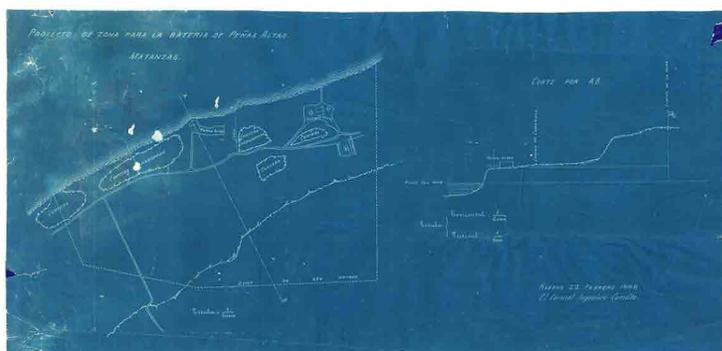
Plano y perfil del proyecto de zona para la batería de Peñas Altas (CUB-27-07), realizado en La Habana, por Enrique Amado Salazar, el 22 de febrero de 1886. Este plano indica las canteras adyacentes a la batería, de donde posiblemente se extrajo material para su construcción, remodelación y aumento en el siglo XIX. Fuente: AHMM.
